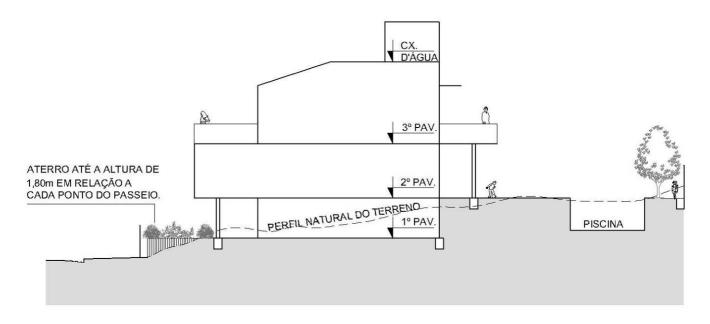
Elemento construtivo no afastamento frontal terreno em aclive: aterro até 1,80m
